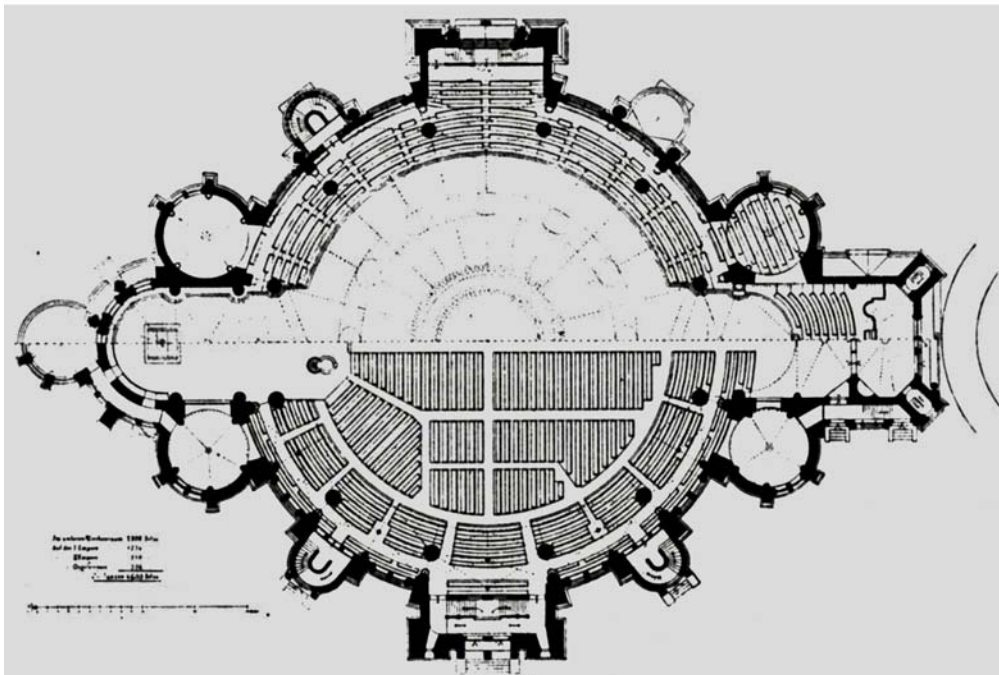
August Orth, Entwurf für eine zweite Kirche in Essen (1899), Grundriss Erdgeschoss
